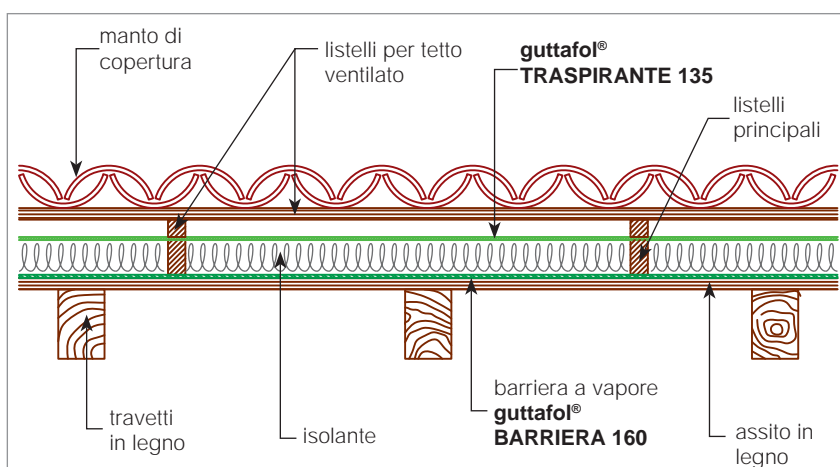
guttafol® TRASPIRANTE 135 sopra l'isolamento con camera di ventilazione
